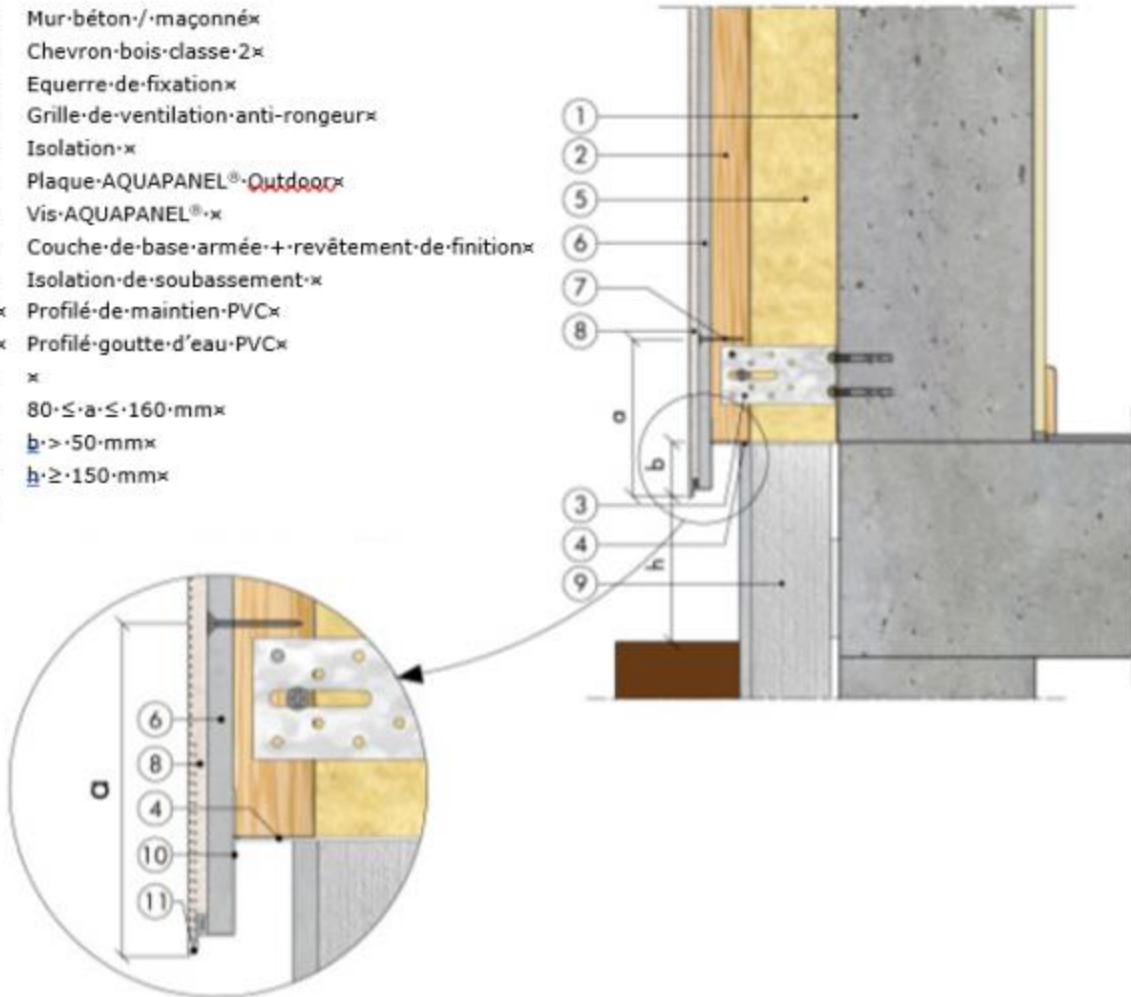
Départ du bardage – Coupe verticale sur ossature bois
